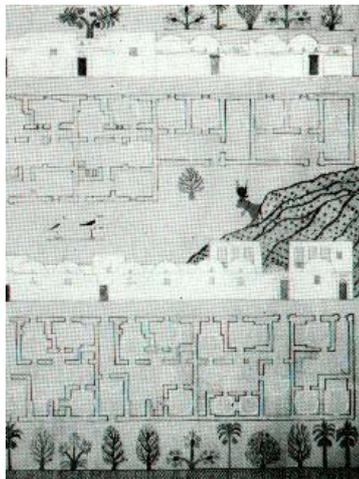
Plans d'assemblage du village Gournas (Hassan Fathy).
